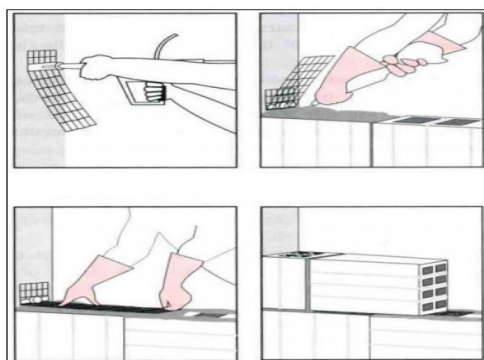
reforços no encontro alvenaria e estrutura (trabalho não publicado)¹¹
